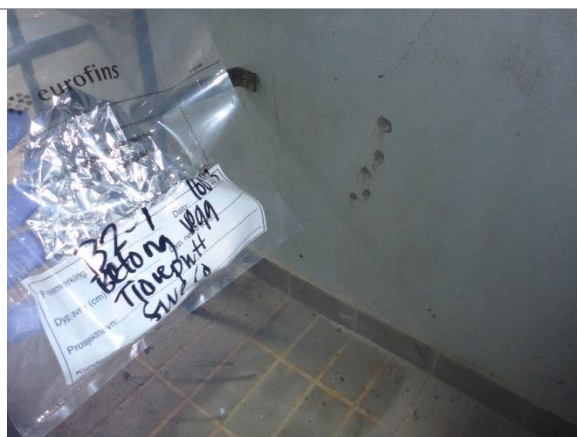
Bygg 1 Betongsøyler i vegg (prøvested B1-4)
